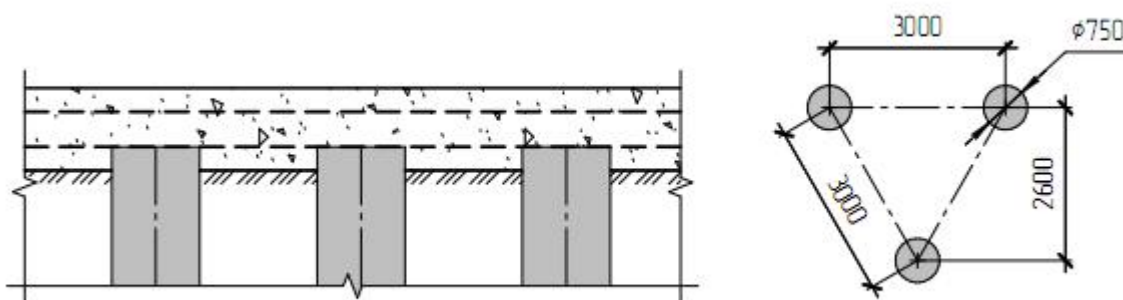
Схема укрепления основания грунтоцементными колоннами
